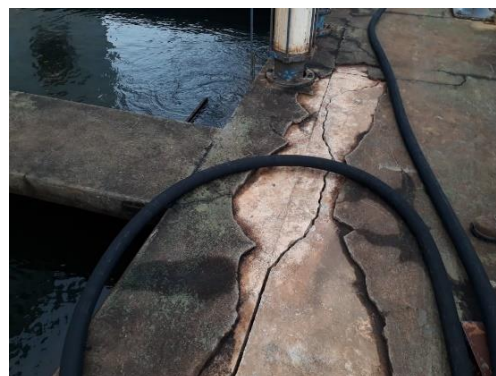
Rachaduras aparentes entre o filtro e decantados.
